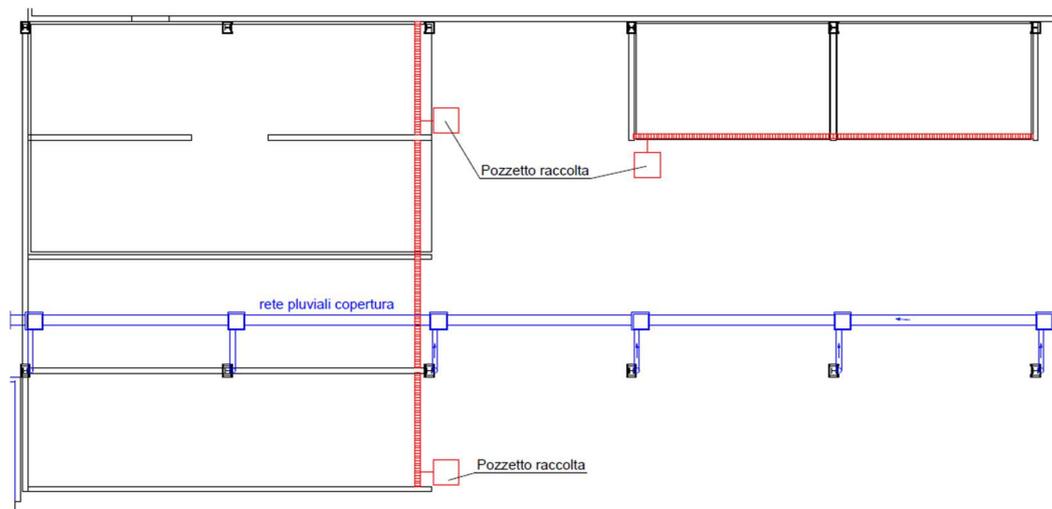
Particolare della planimetria scarichi inclusa nel Progetto Approvato; si notino le canalette per l'intercettazione di eventuali colaticci dalle aree di stoccaggio fanghi
